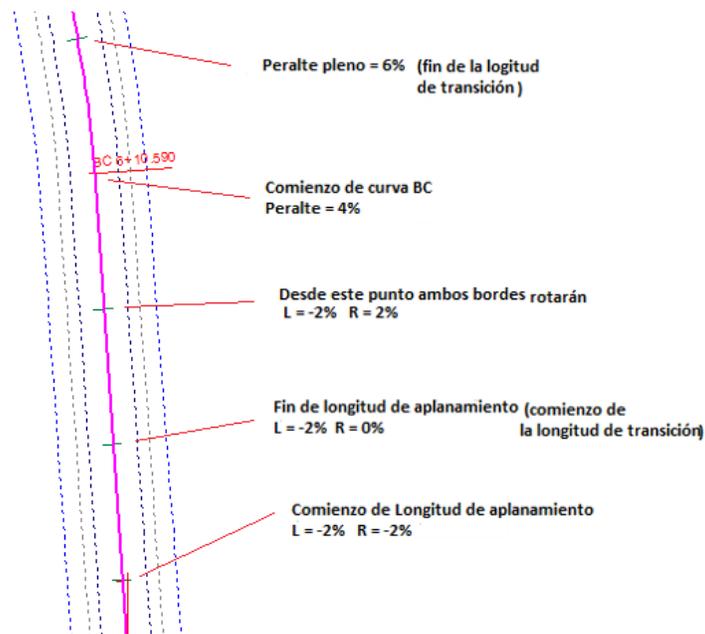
Vista de Planta con Puntos de Transición (Barras Verdes)
